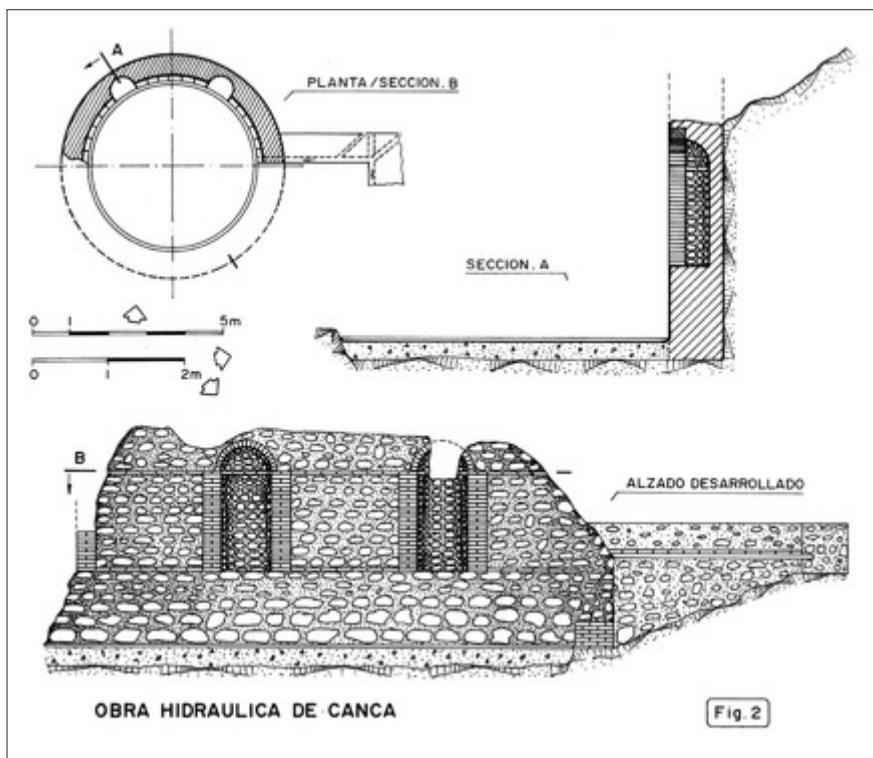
Planimetría de las termas romanas de Canca (Álora). Recio Ruiz, Á. (1987)
